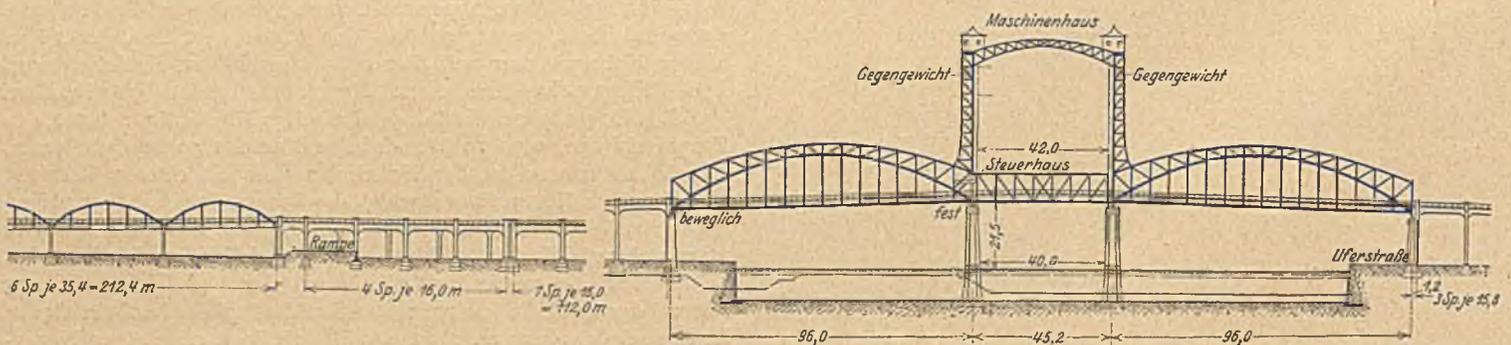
Hafenbrücke mit westlich anschließender Rampenbrücke.
